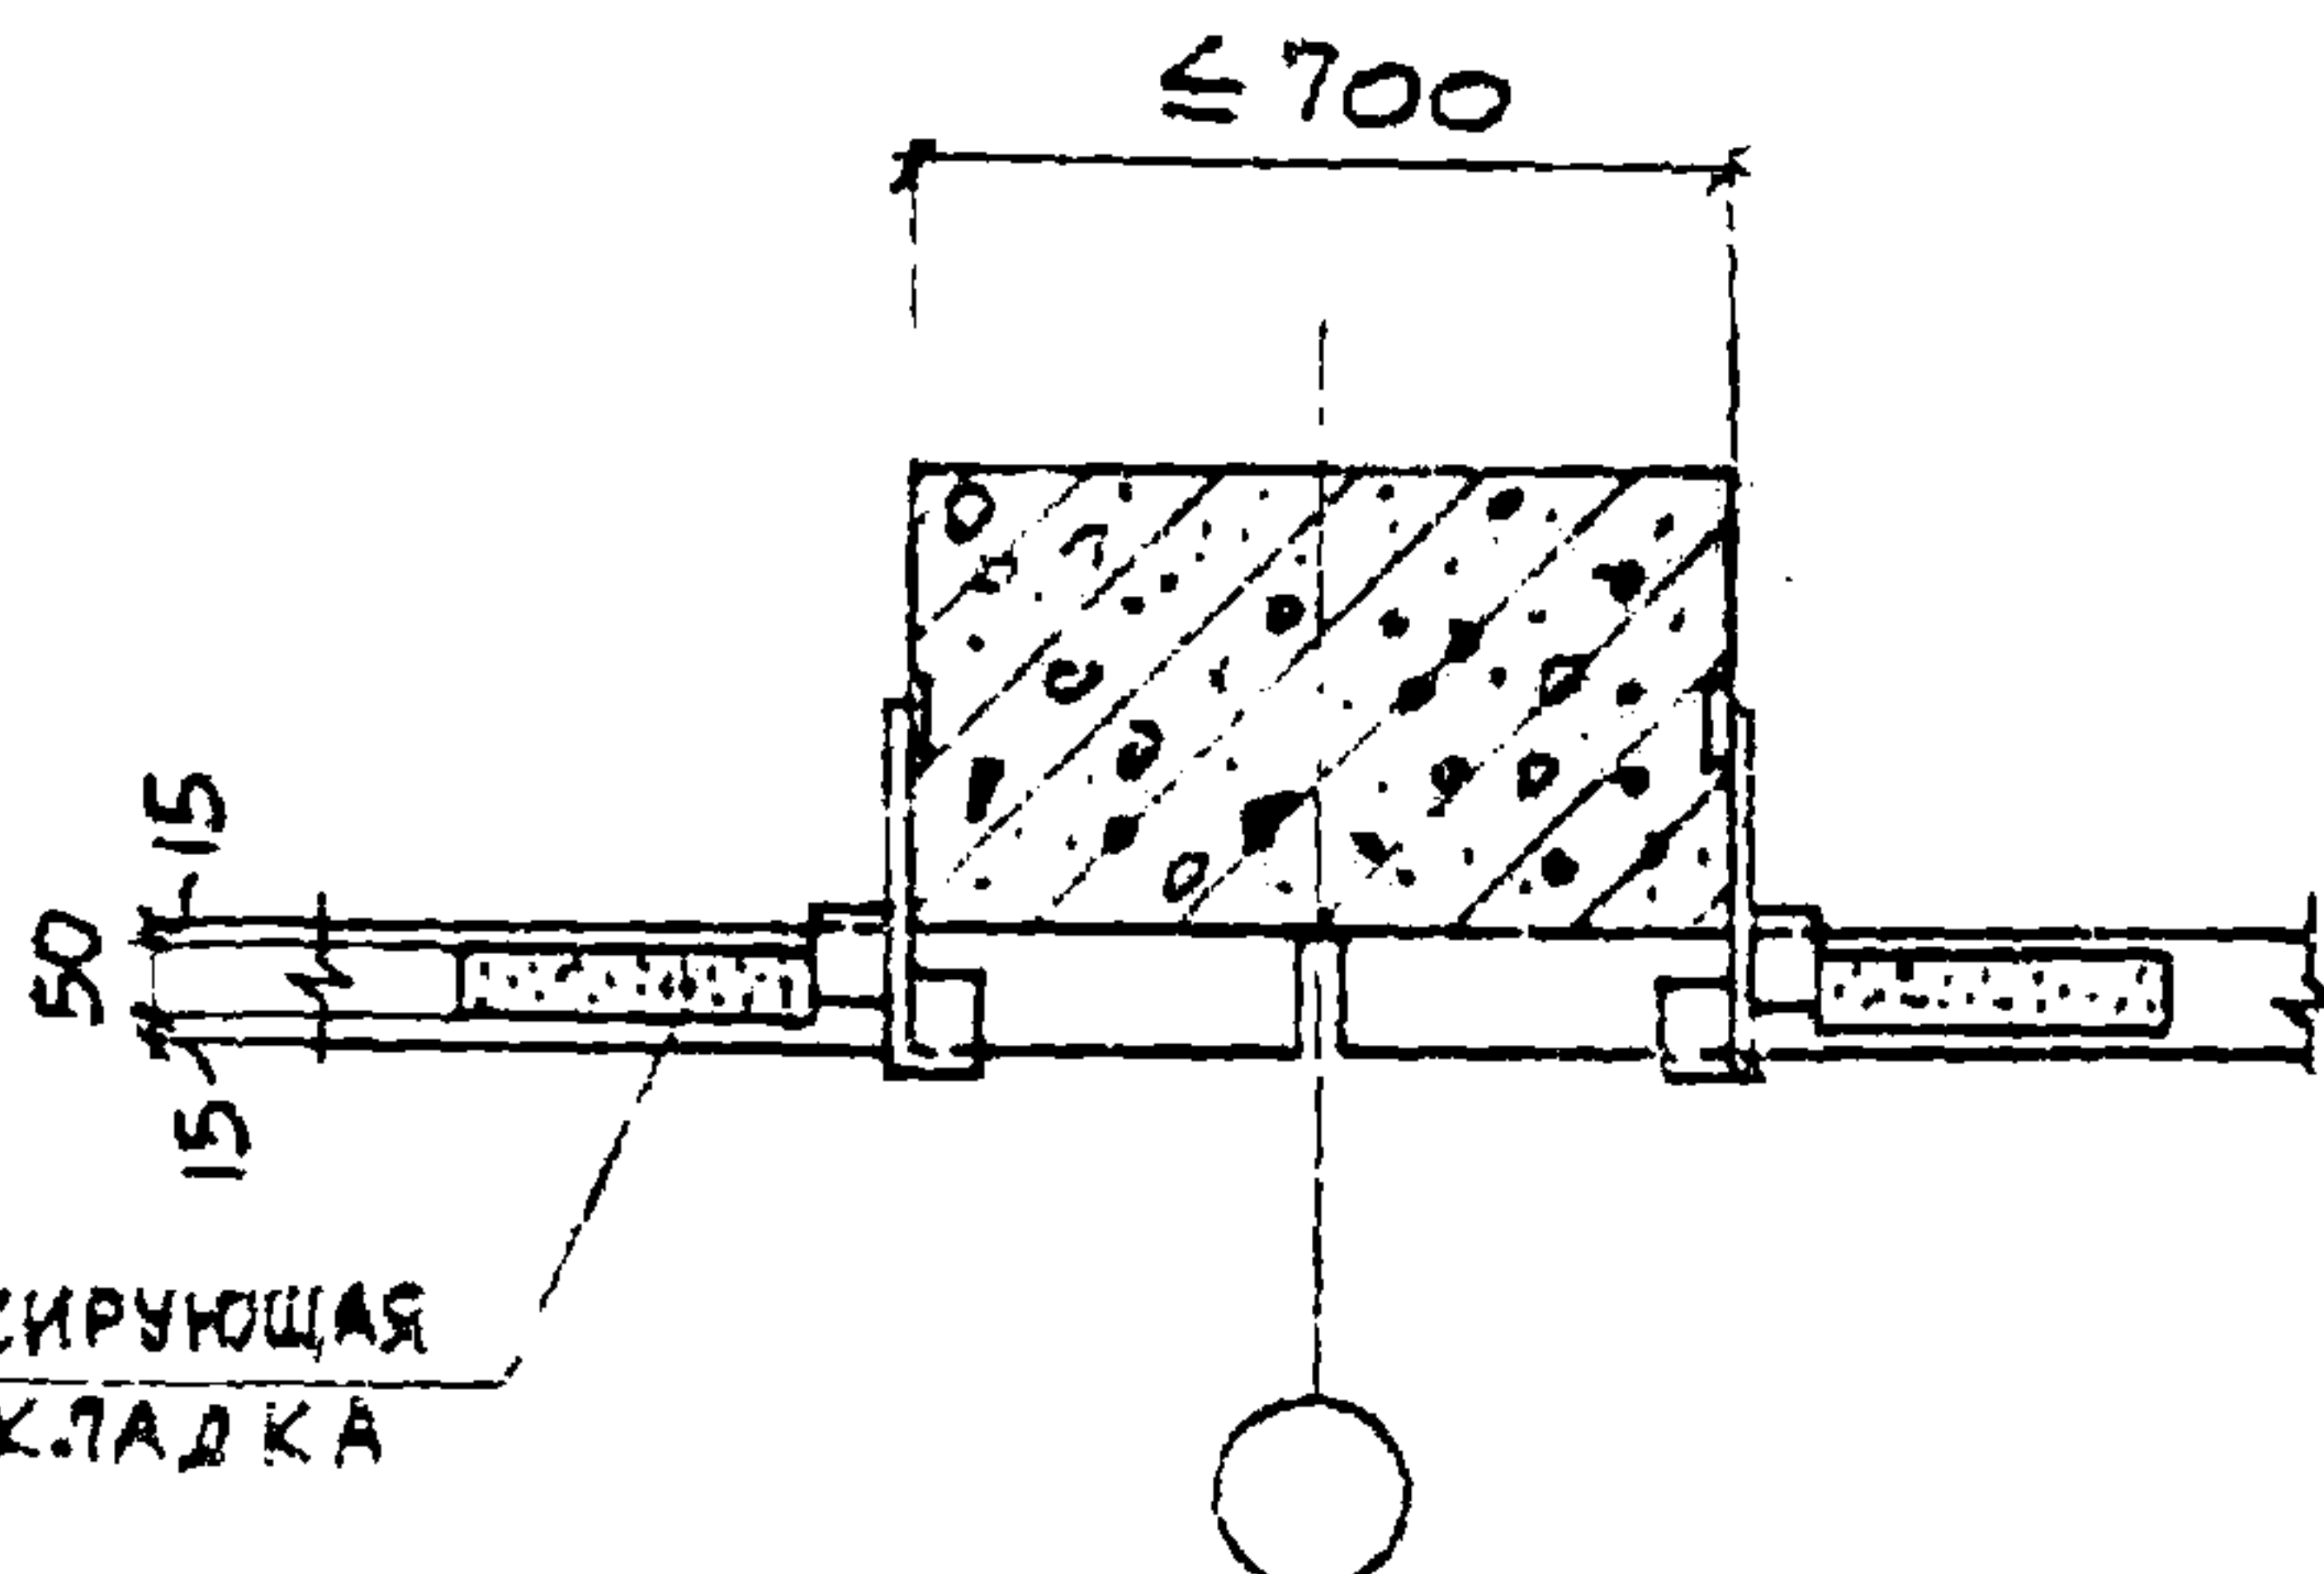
В поперечных перегородках у средних колонн здания с высотой сечения колонны ≤ 700 и у рахверковых колонн
